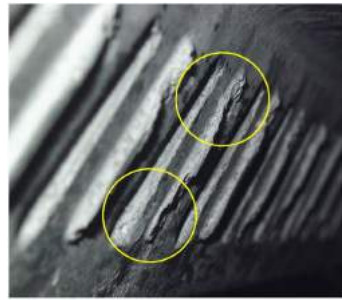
Rotura por corte longitudinal - interface após ensaio de flexão (adaptado de [17])
